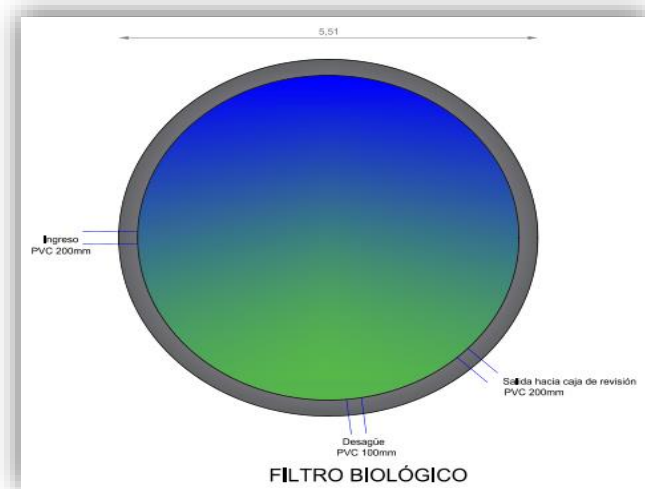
Gráfico en planta del Fafa (Ver anexo 1)
